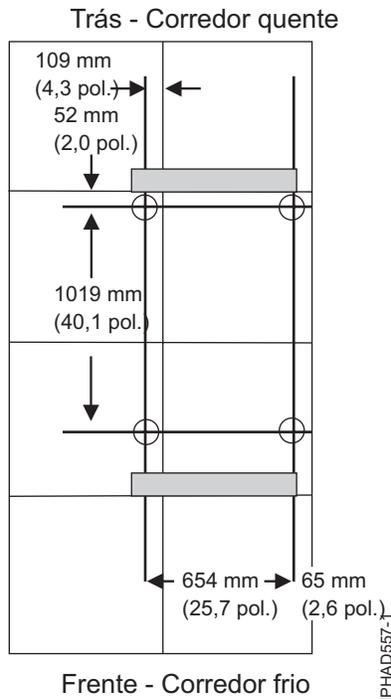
Padrão do buraco de fixação do rack único. Figura do piso elevado com painéis de piso de 610 mm (24 pol.)
